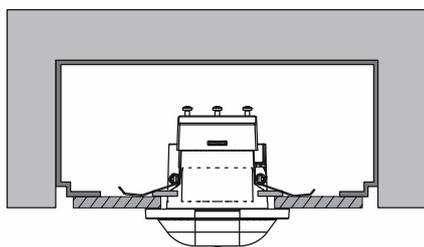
Situazione di montaggio: soffitto in calcestruzzo
